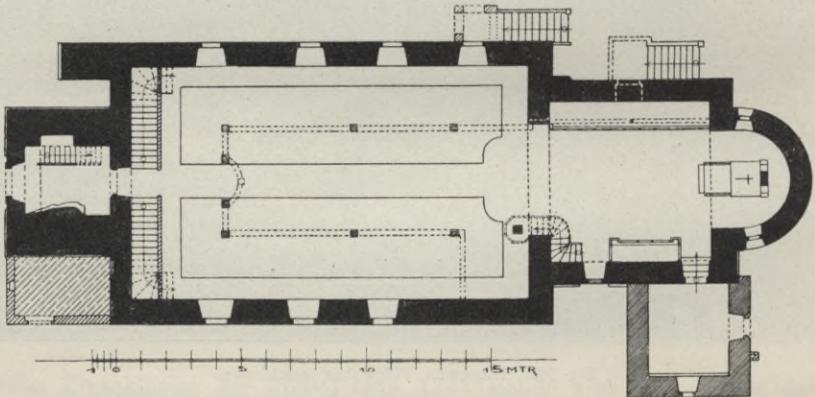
Lorenzkirch, Kirche, Grundriß.
